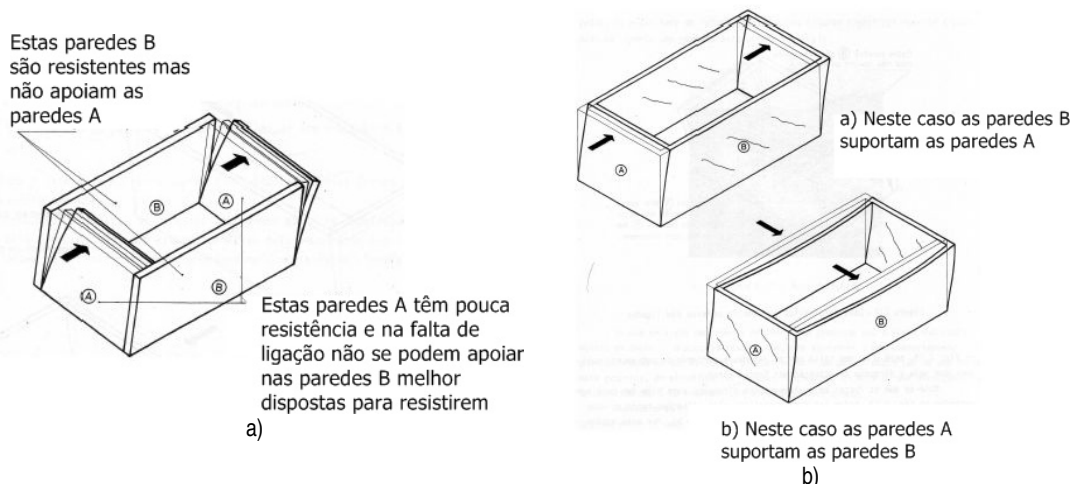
Efeitos da ligação entre paredes: a) fraca ligação entre paredes; b) forte ligação entre paredes (Candeias, 2008)
